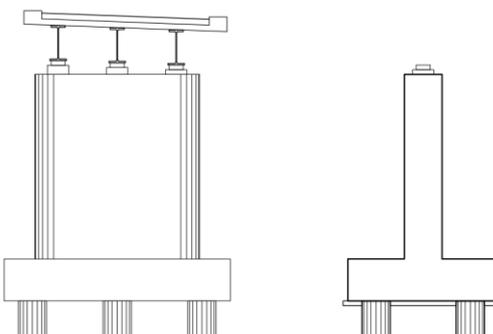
Sezione Strutturale Tipo del Viadotto
